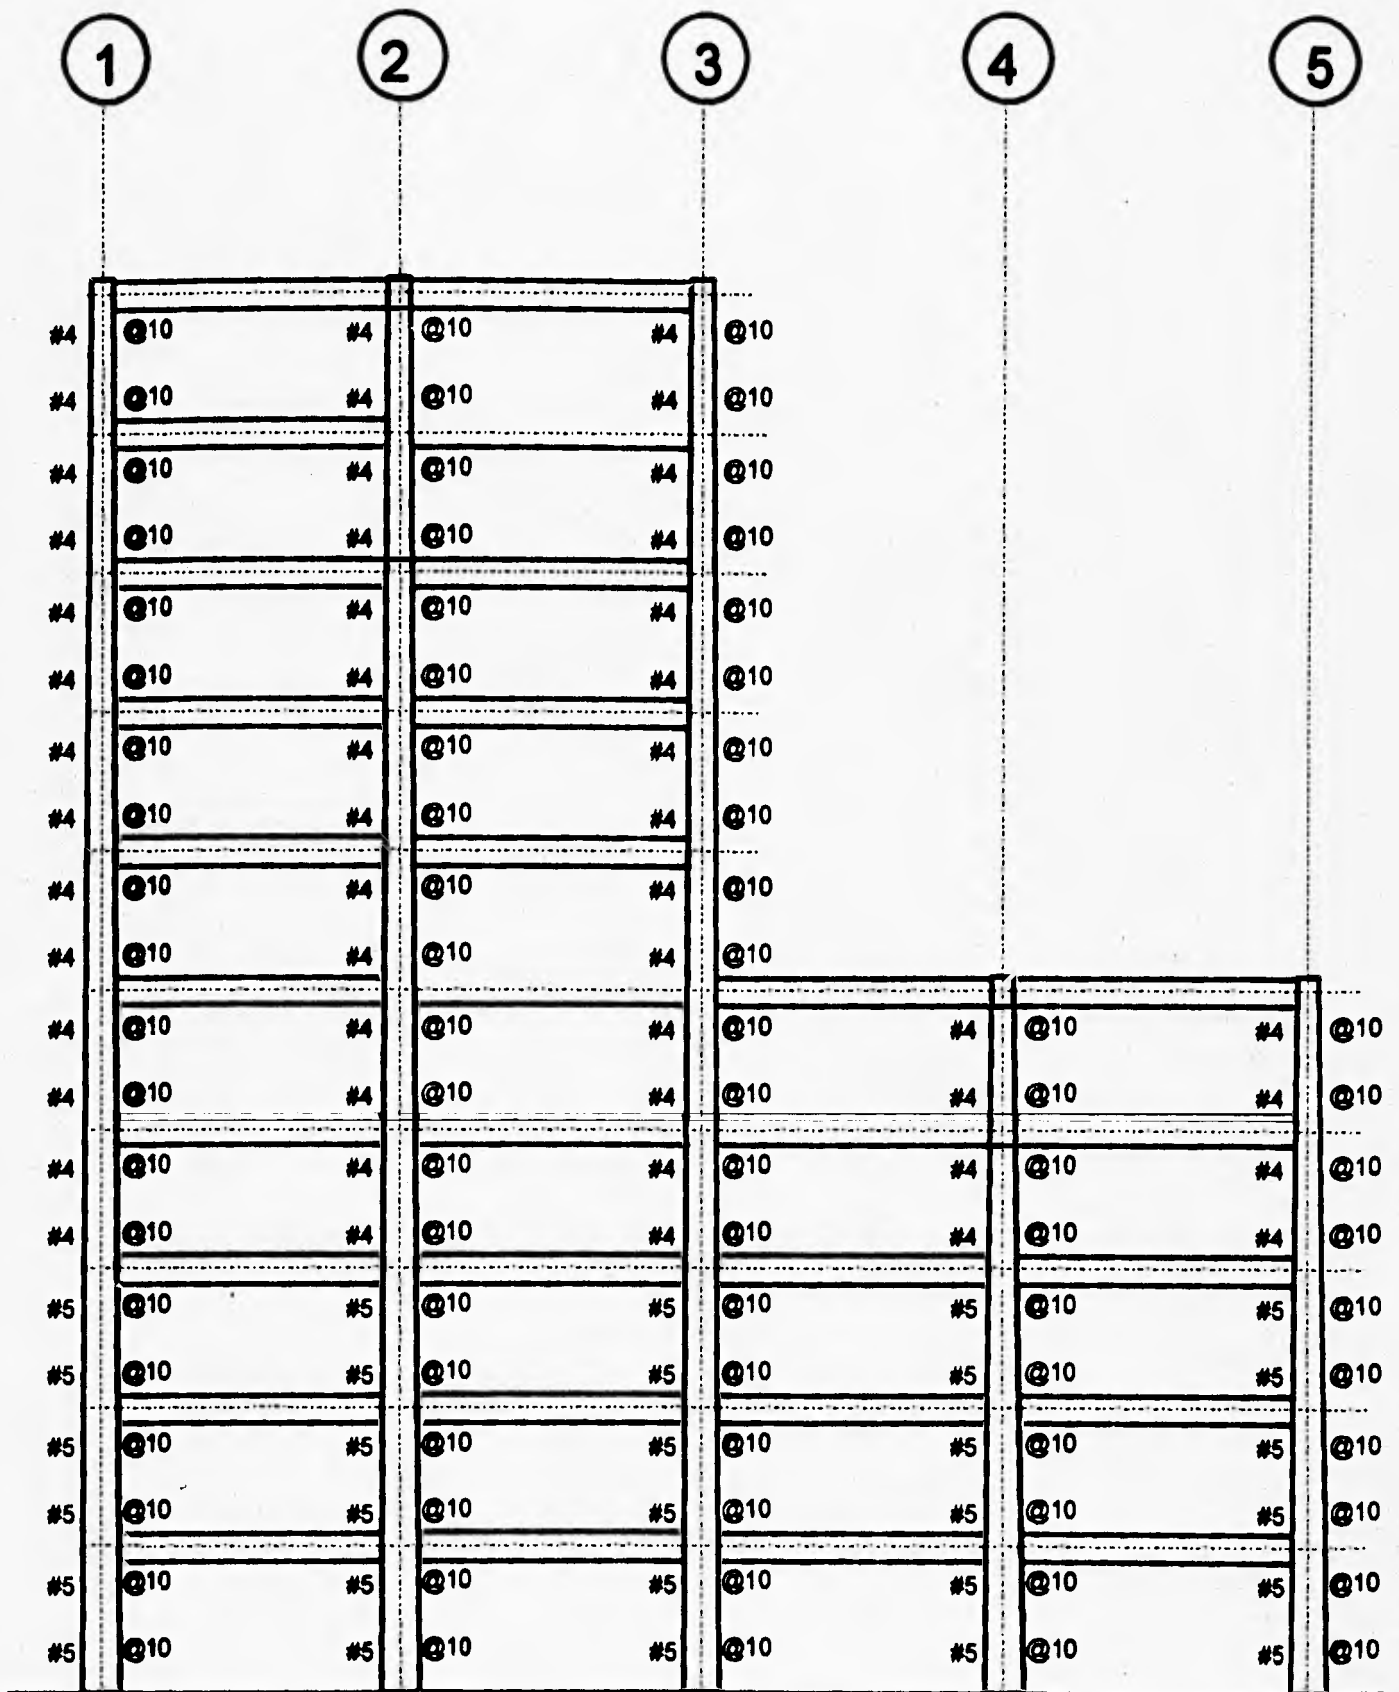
Distribución de Refuerzo Transversal en Zonas Críticas de Columnas, Primer Modelo, $Q = 4.0$
